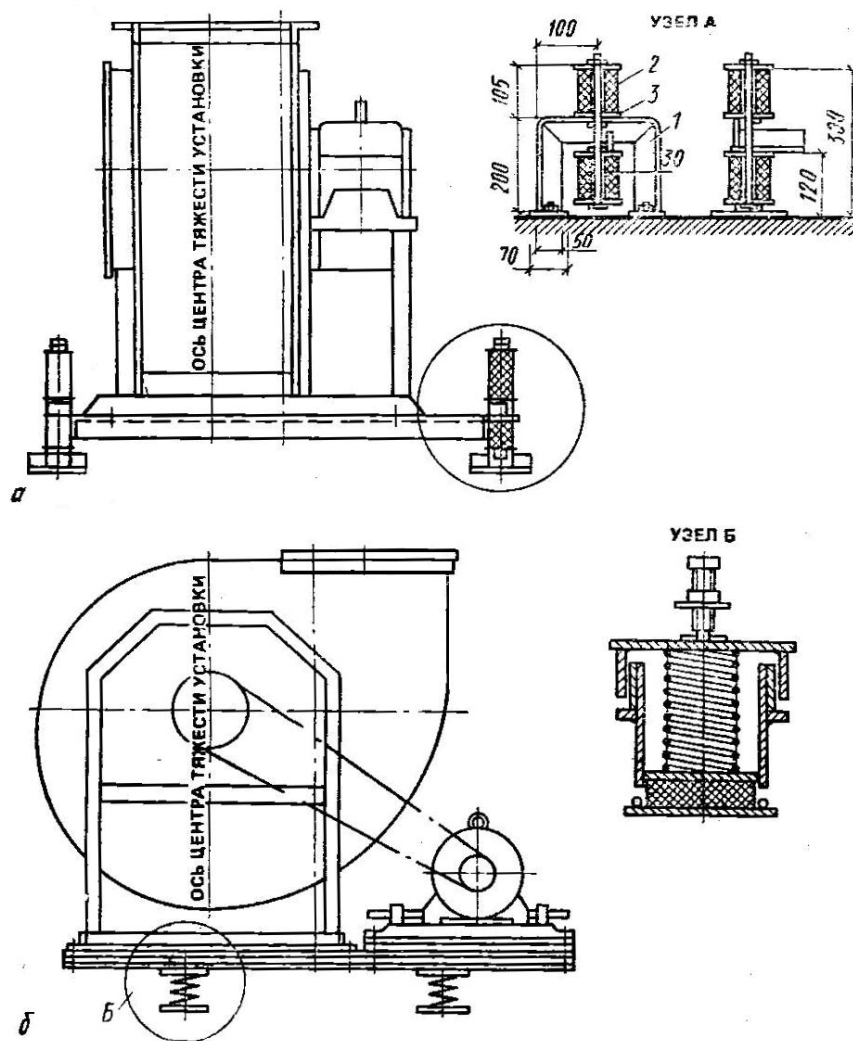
Установка вентиляторов на виброизолирующих основах с резиновыми (а) и пружинными (б) виброизоляторами: 1 – опорная конструкция; 2 – резиновый цилиндр; 3 – металлические шайбы
